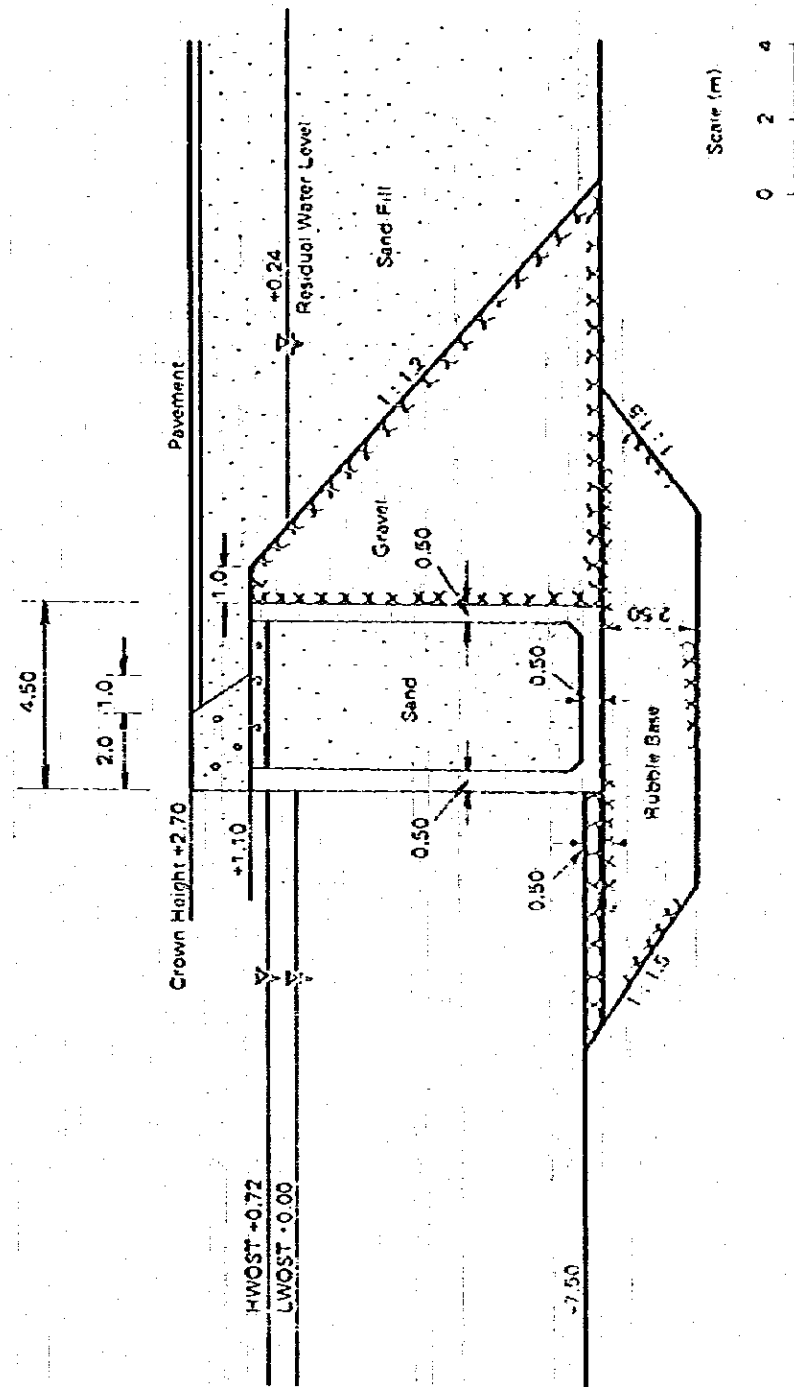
(b) 電力式ケーソン標準平面図 (— 7.5 m)
